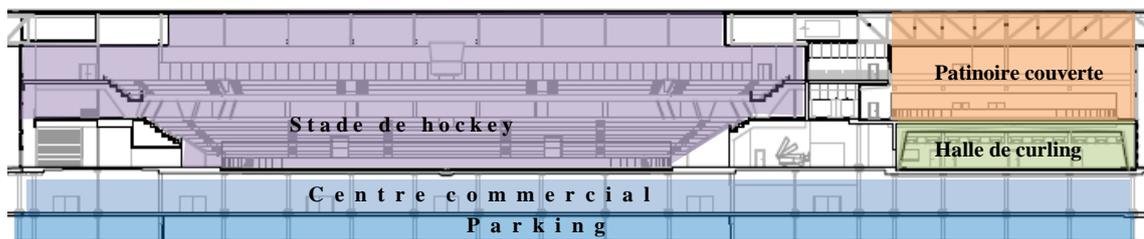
Coupe sur le Stade de hockey et le halle de curling.
